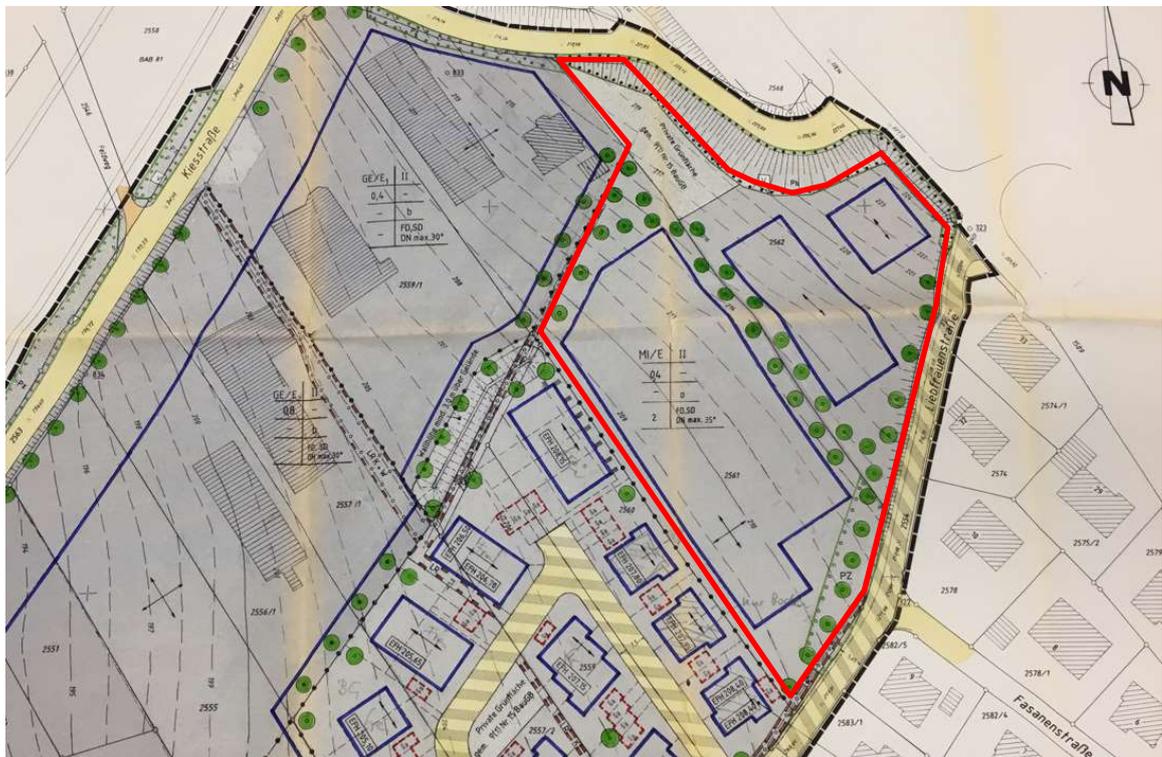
Ausschnitt aus dem Bebauungsplan ‚Obere Kappel, 2.+3.Änderung‘ [15] mit Darstellung des geplanten Geltungsbereichs der 5.Änderung (Darstellung aufgrund der Abfotografie etwas verzerrt)
